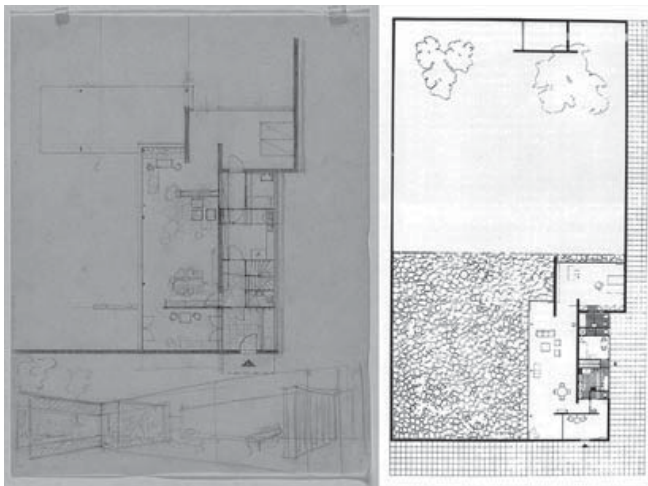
Croquis de planta con correcciones y perspectiva a mano de Mies y planta definitiva de una vivienda patio. Autor Howard Dearstyne 41931.
